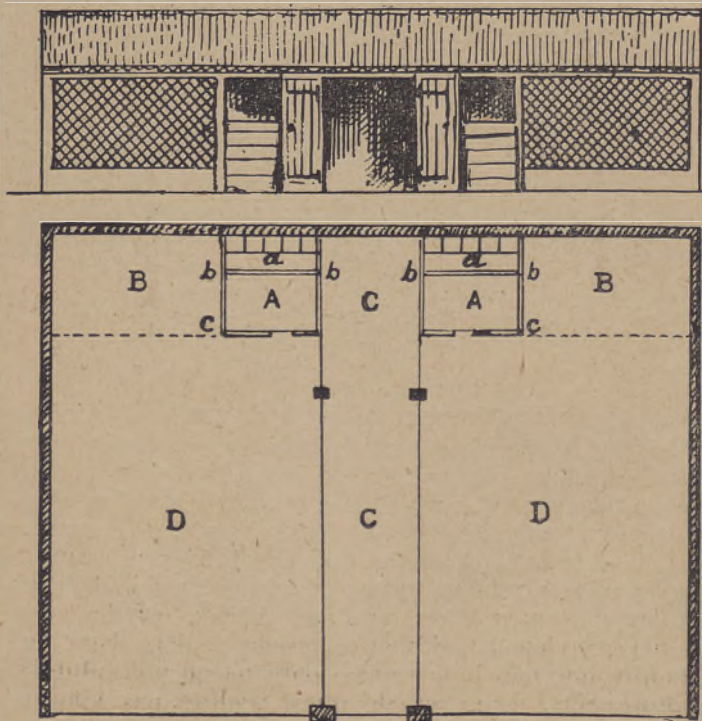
Galinheiro rural-fixo. em cima, alçado, em baixo, planta
